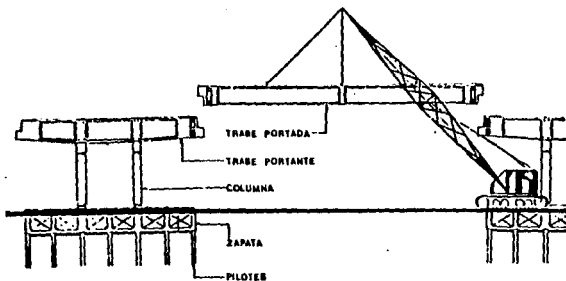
MONTAJE DE TRABES CENTRALES
